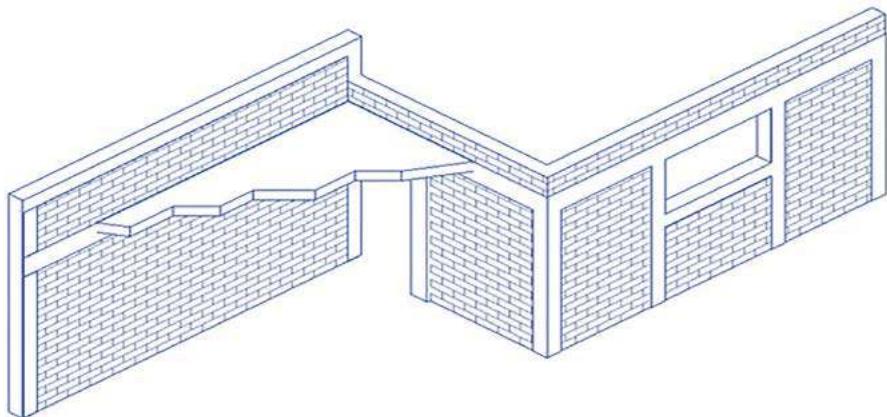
Sistema de muros de mampostería confinada. Imagen del autor.
